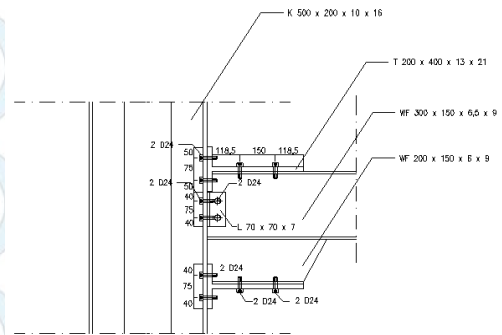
Sambungan Kolom dan Kolom Lantai 6
